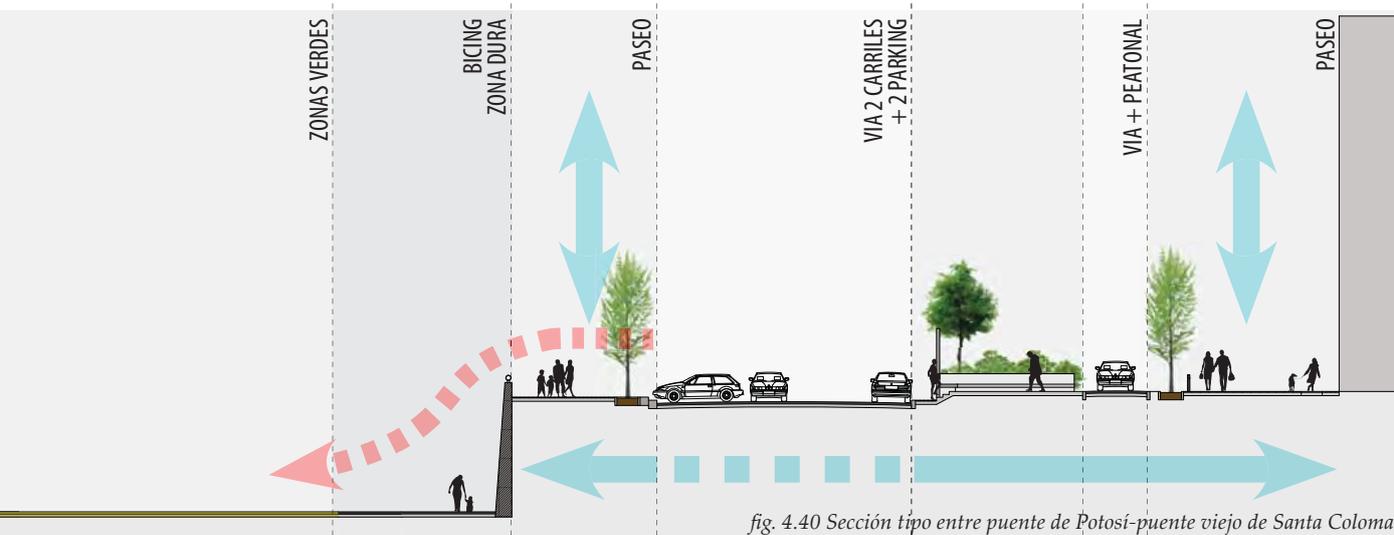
Sección tipo entre puente de Potosí-puente viejo de Santa Coloma
